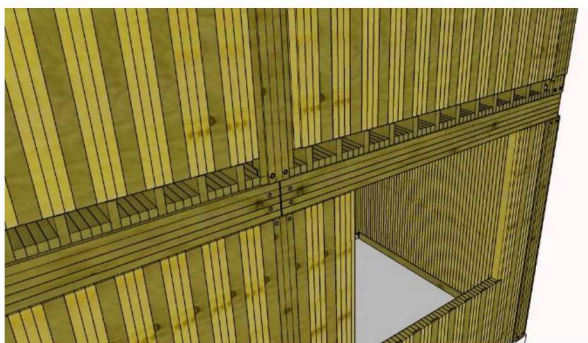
Detalle de losa y muros de segundo piso sin revestir
